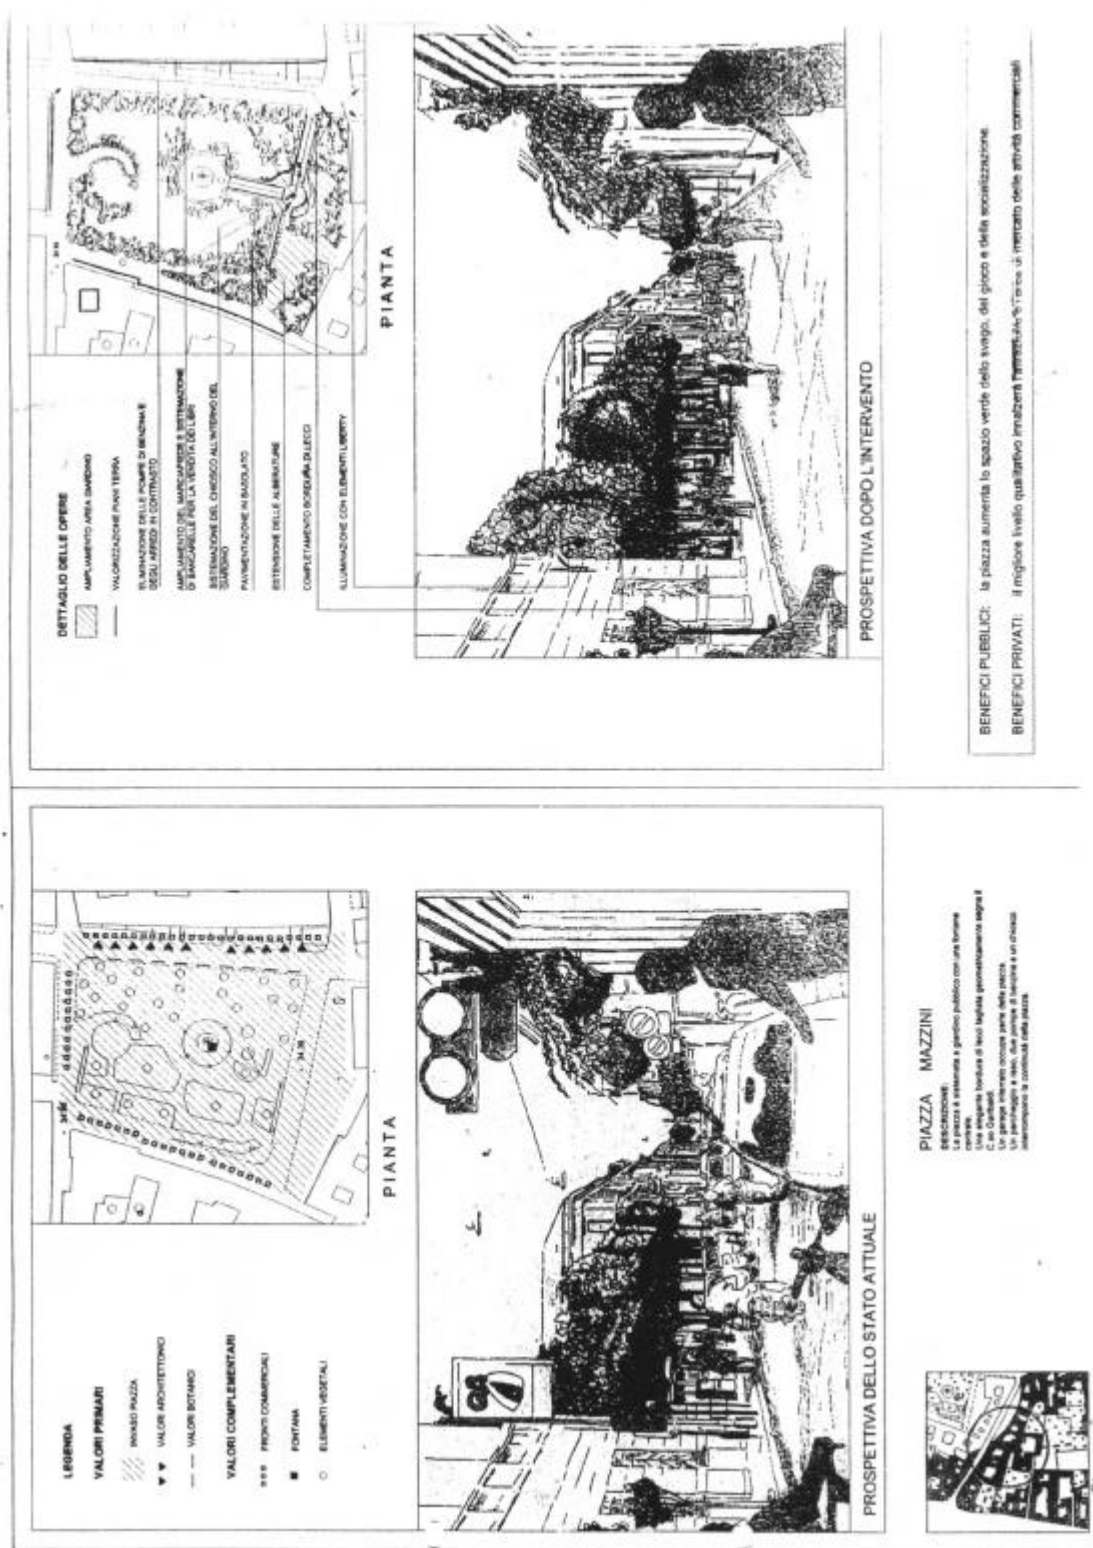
l'innovazione funzionale nel perimetro della zona di interesse storico: la riqualificazione delle piazze centrali
